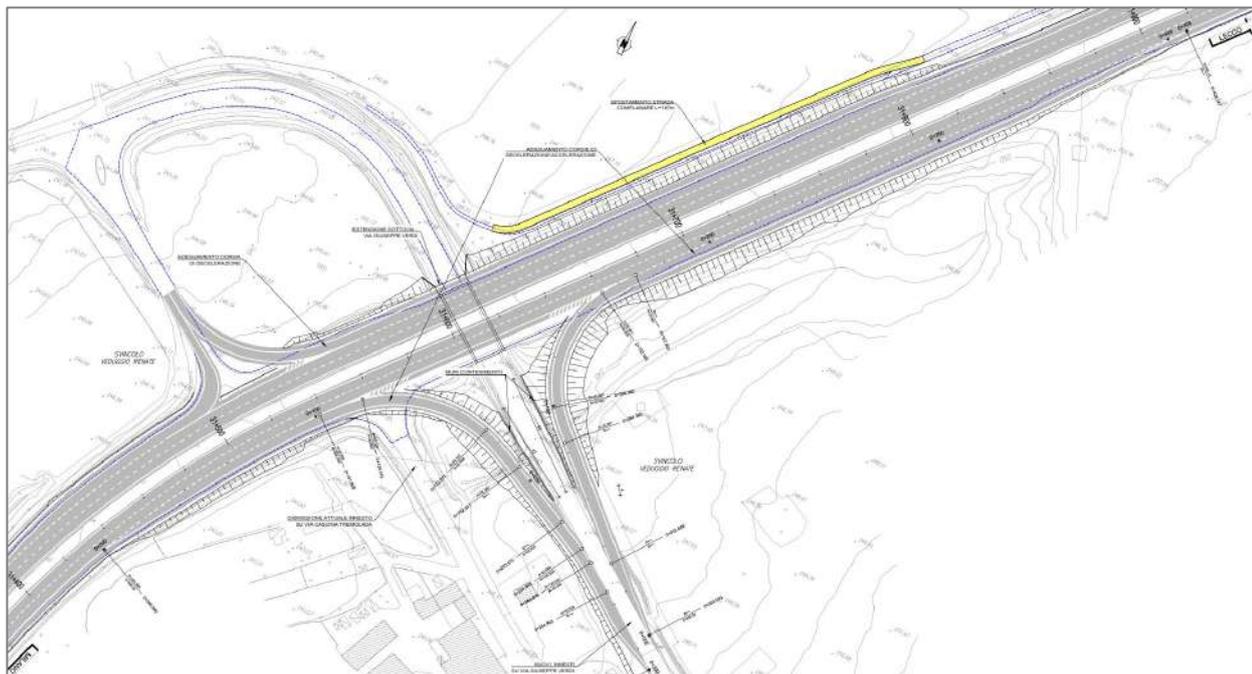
Planimetria di Progetto Svincolo di Veduggio con Colzano
